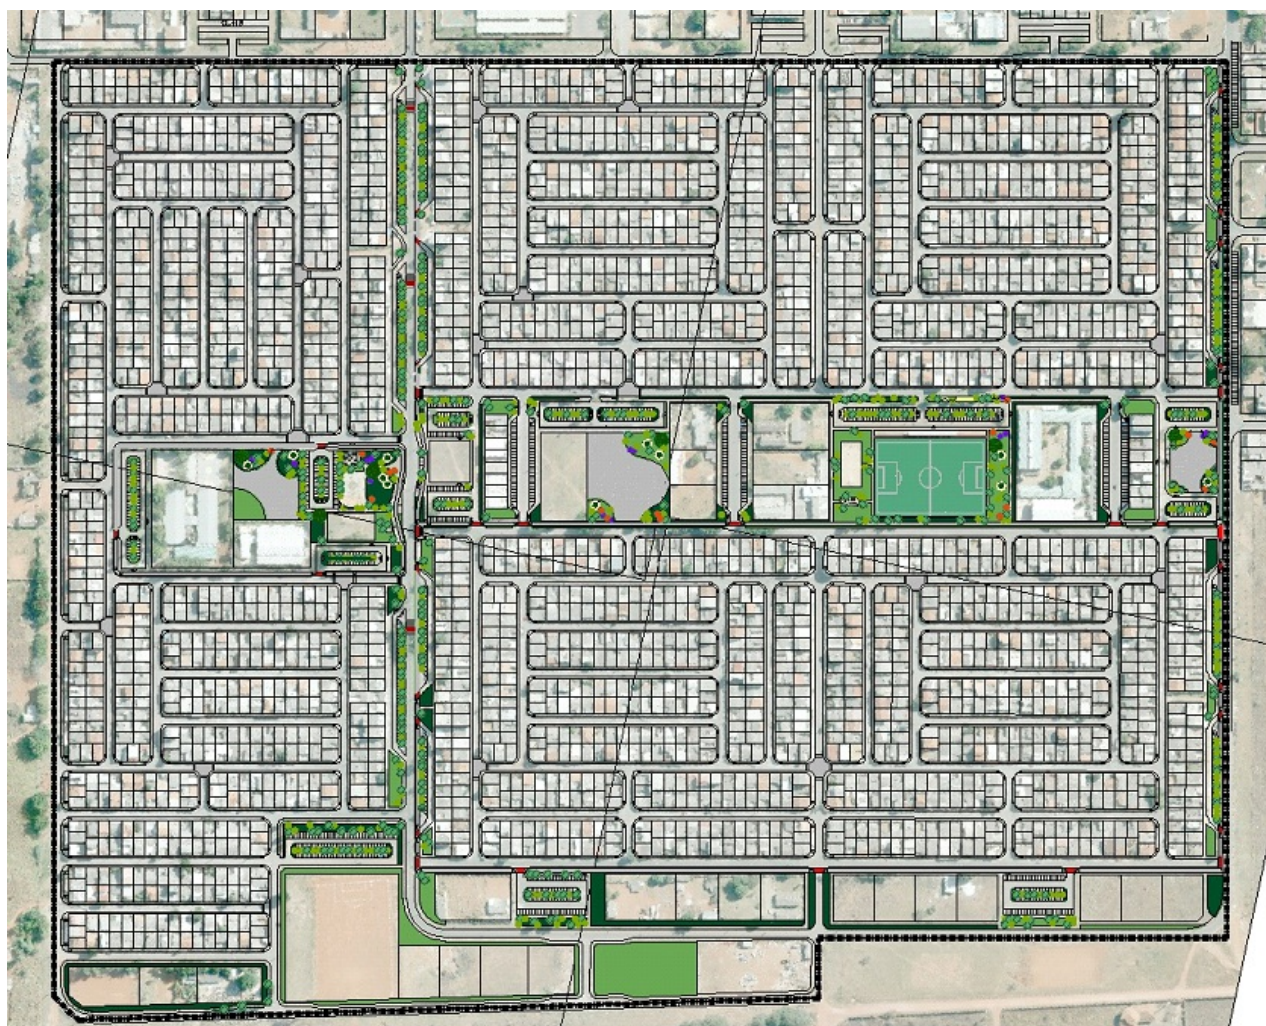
Visão geral do parcelamento com as praças na faixa central.
